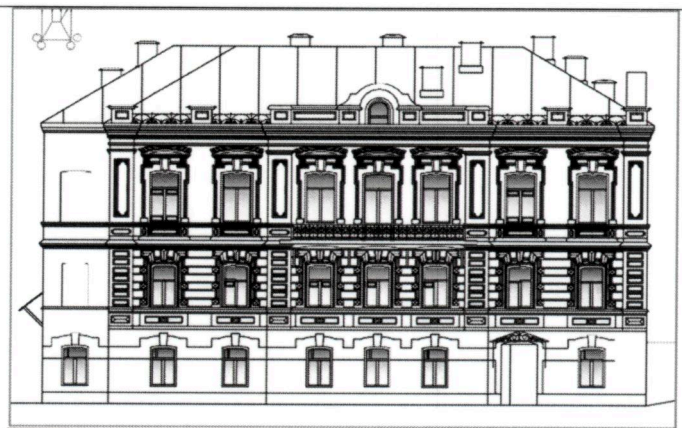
Главный фасад по улице Япеева (западный фасад)
